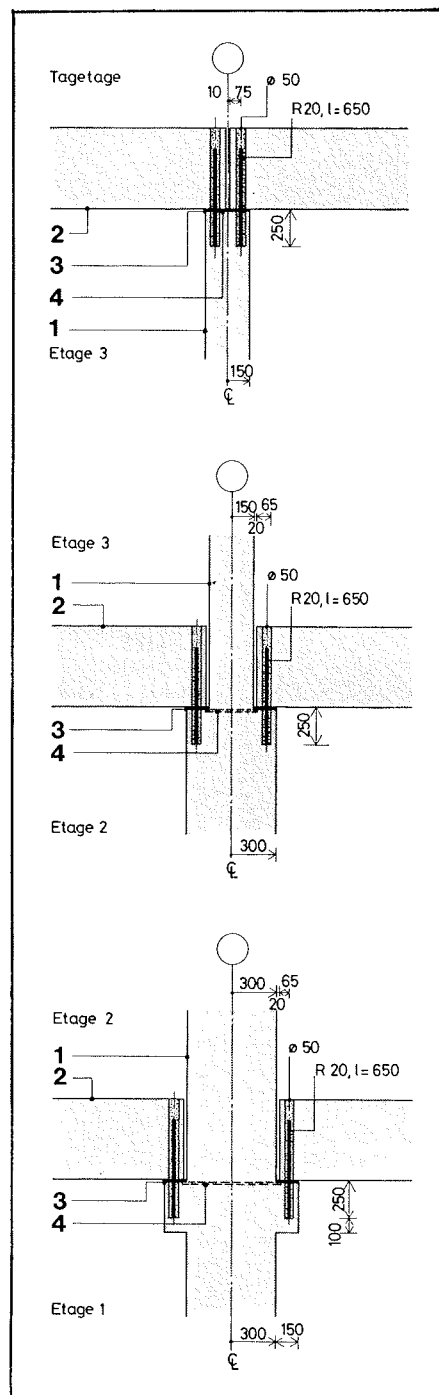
Søjleelement, 1:1000. Søjlearmering K20 er ikke vist; knastarmering er i princip vist på søjlens nederste knast: vandret 4 T14 bøjler, lodret 3 T10 bøjler.
